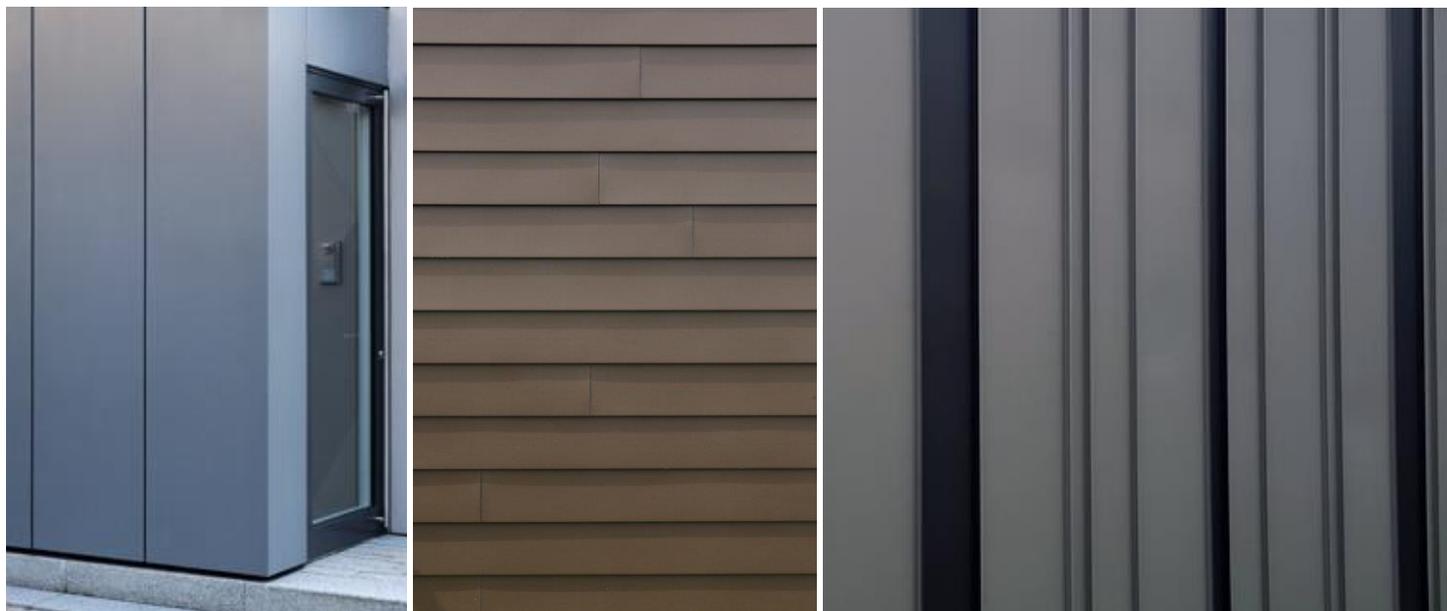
exemples de façades en bardage métallique
